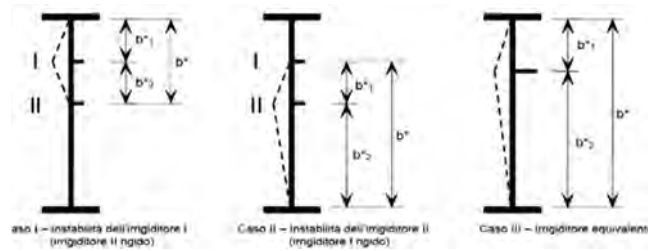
Lastra irrigidita con due irrigiditori nella parte compressa
